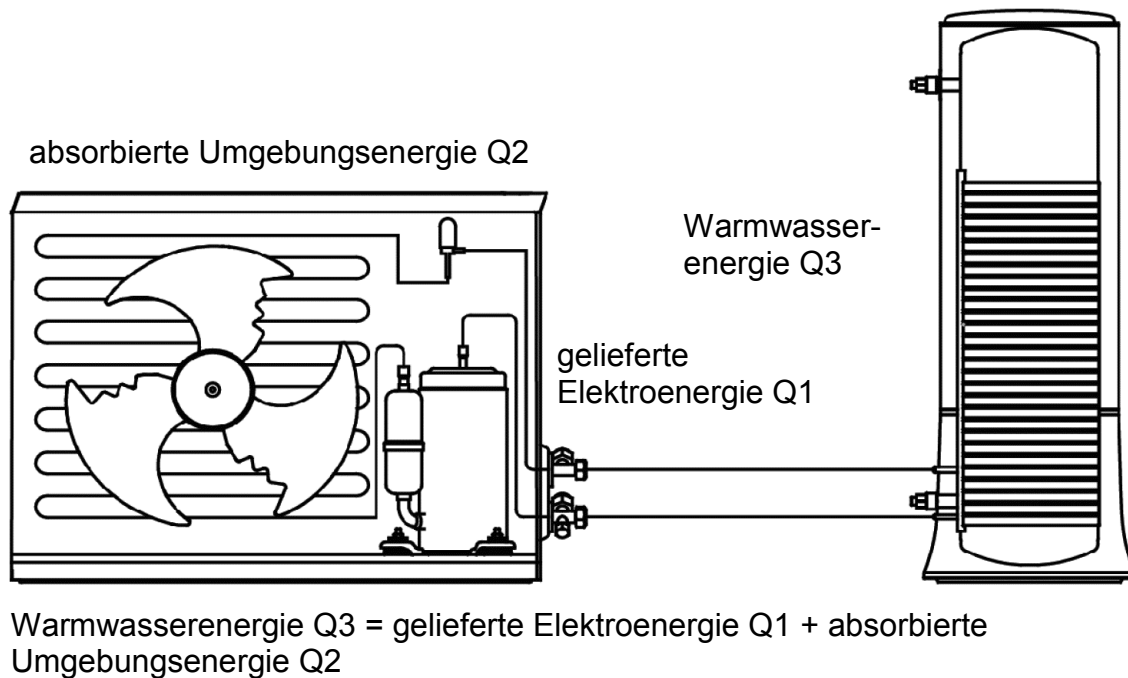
Schaltplan des Warmwasserbereiters mit Luft-Wärmepumpe
